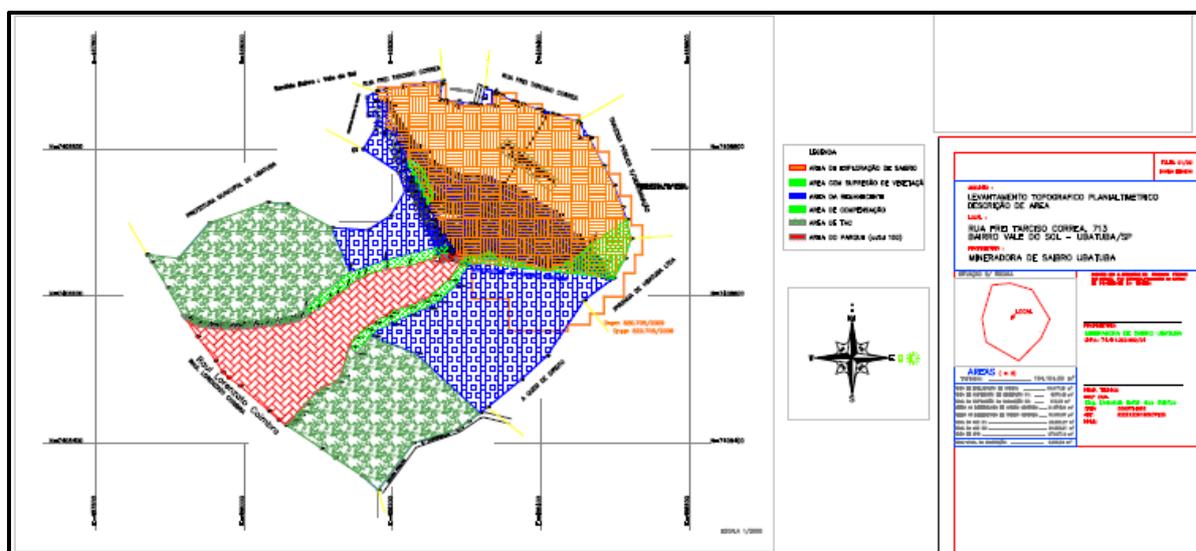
Planta Topográfica Planialtimétrica da Área (área objeto marcada pela poligonal norte-sul x leste-oeste em laranja, com taludes). (Planta em arquivo PDF nos anexos).
